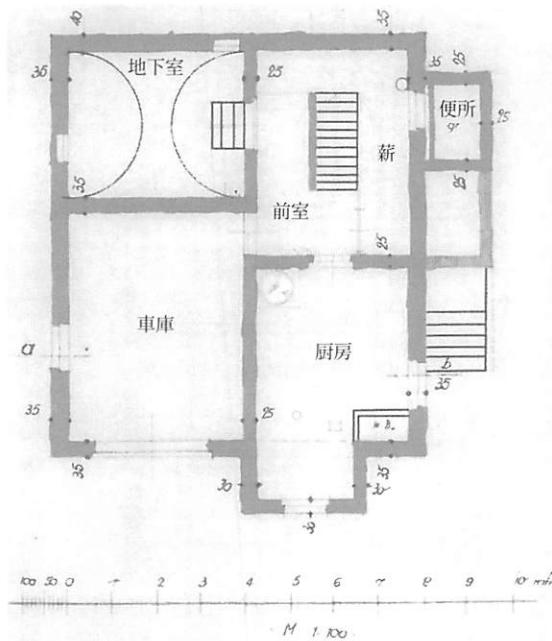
地下室の平面図。地下室は吹き抜けで、1957年の平面図では洗濯室の隅に雨水樹がある。
